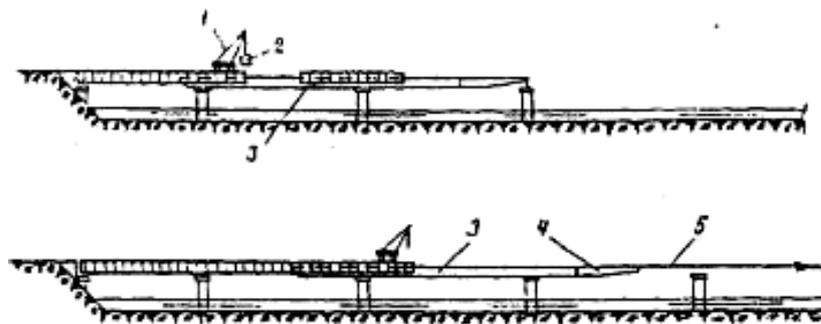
Последовательность сборки на инвентарных передвижных подмостях:
